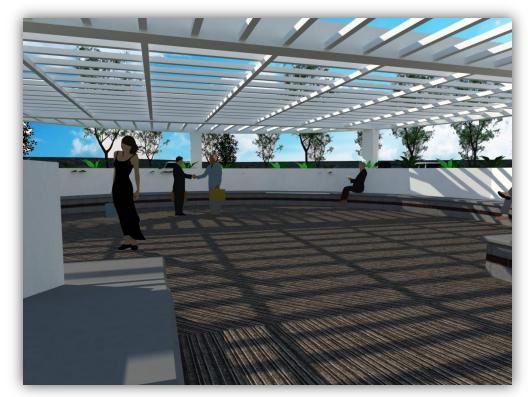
PERSPECTIVA DEL ÁREA TECHADA DEL PROYECTO.
